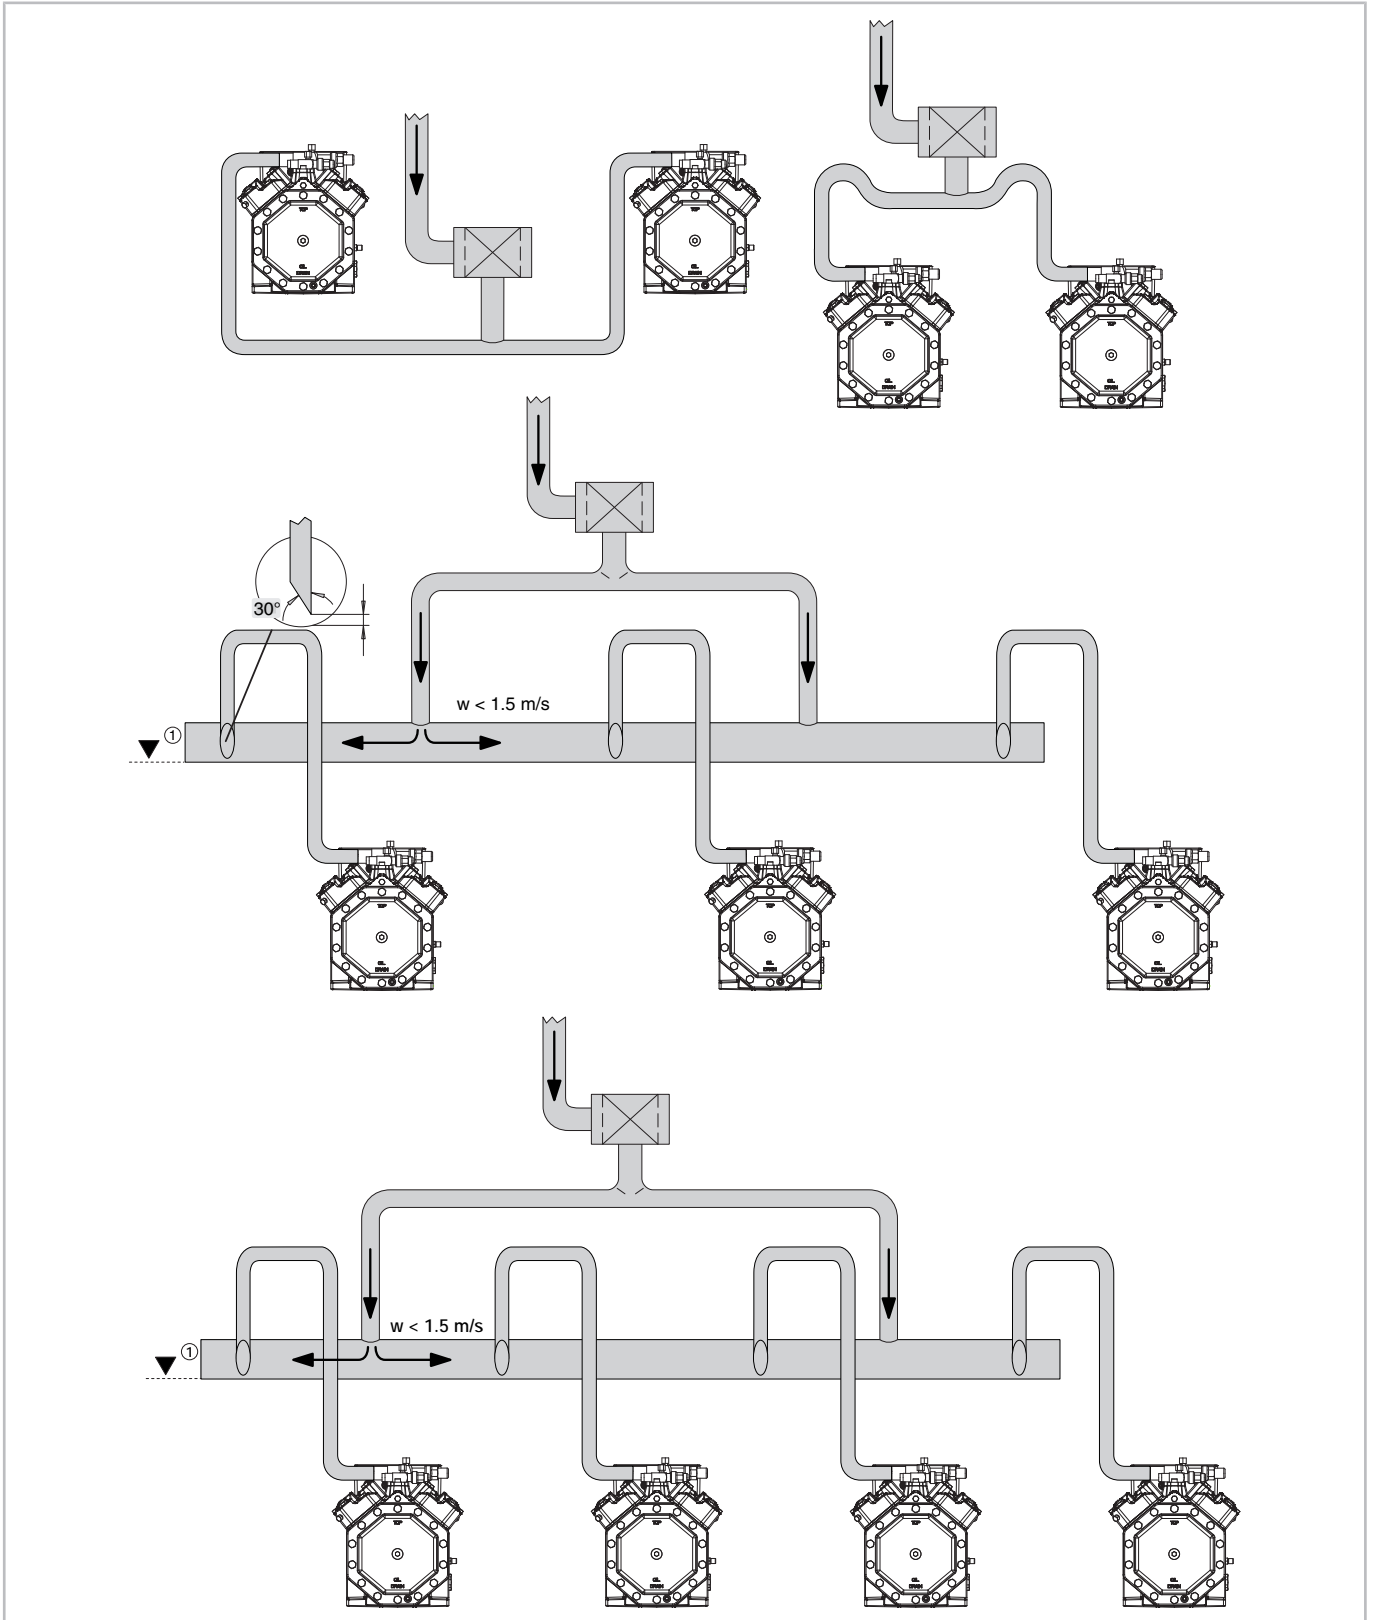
Parallelverbund Hubkolbenverdichter: Ausführung mit optimiertem Saugkollektor
